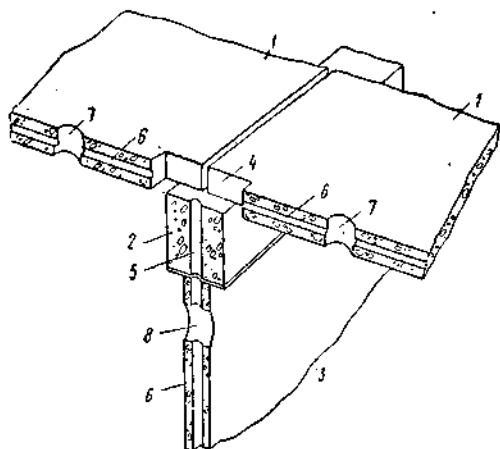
Узел сопряжения потолочных панелей, балки (ригеля) и стеновой панели здания
